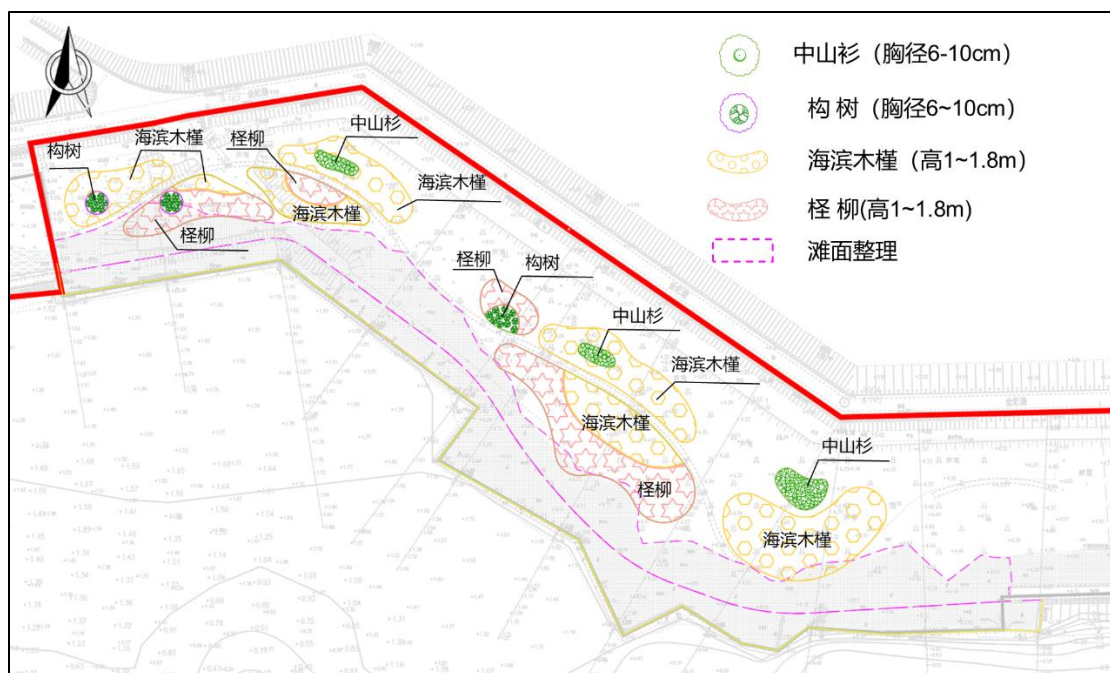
堤外滩涂乔灌木种植示范平面图
